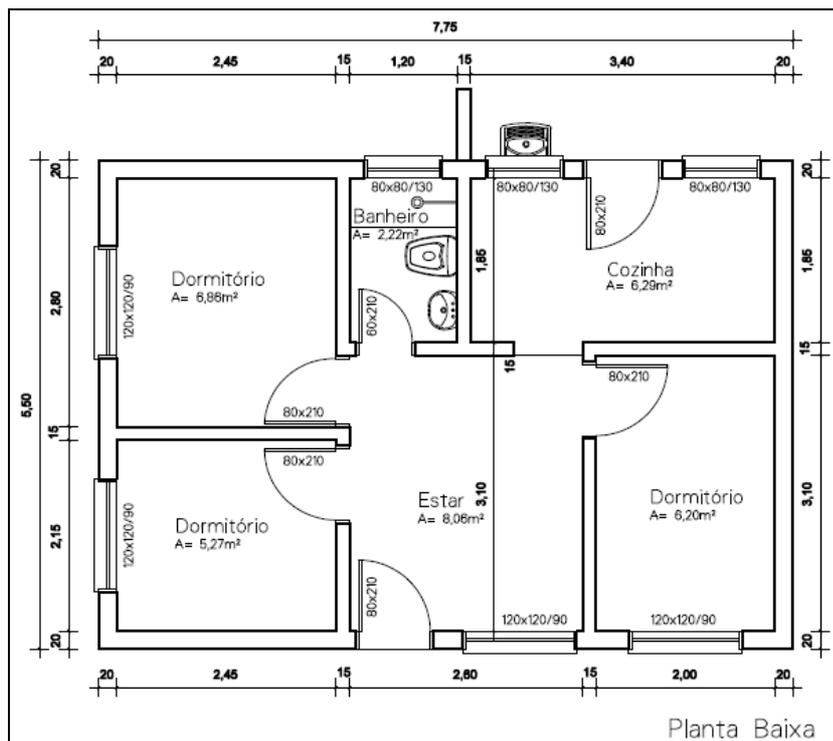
Planta baixa casa 3 dormitórios – Conjunto habitacional COHAB Duque – 42,00m²
